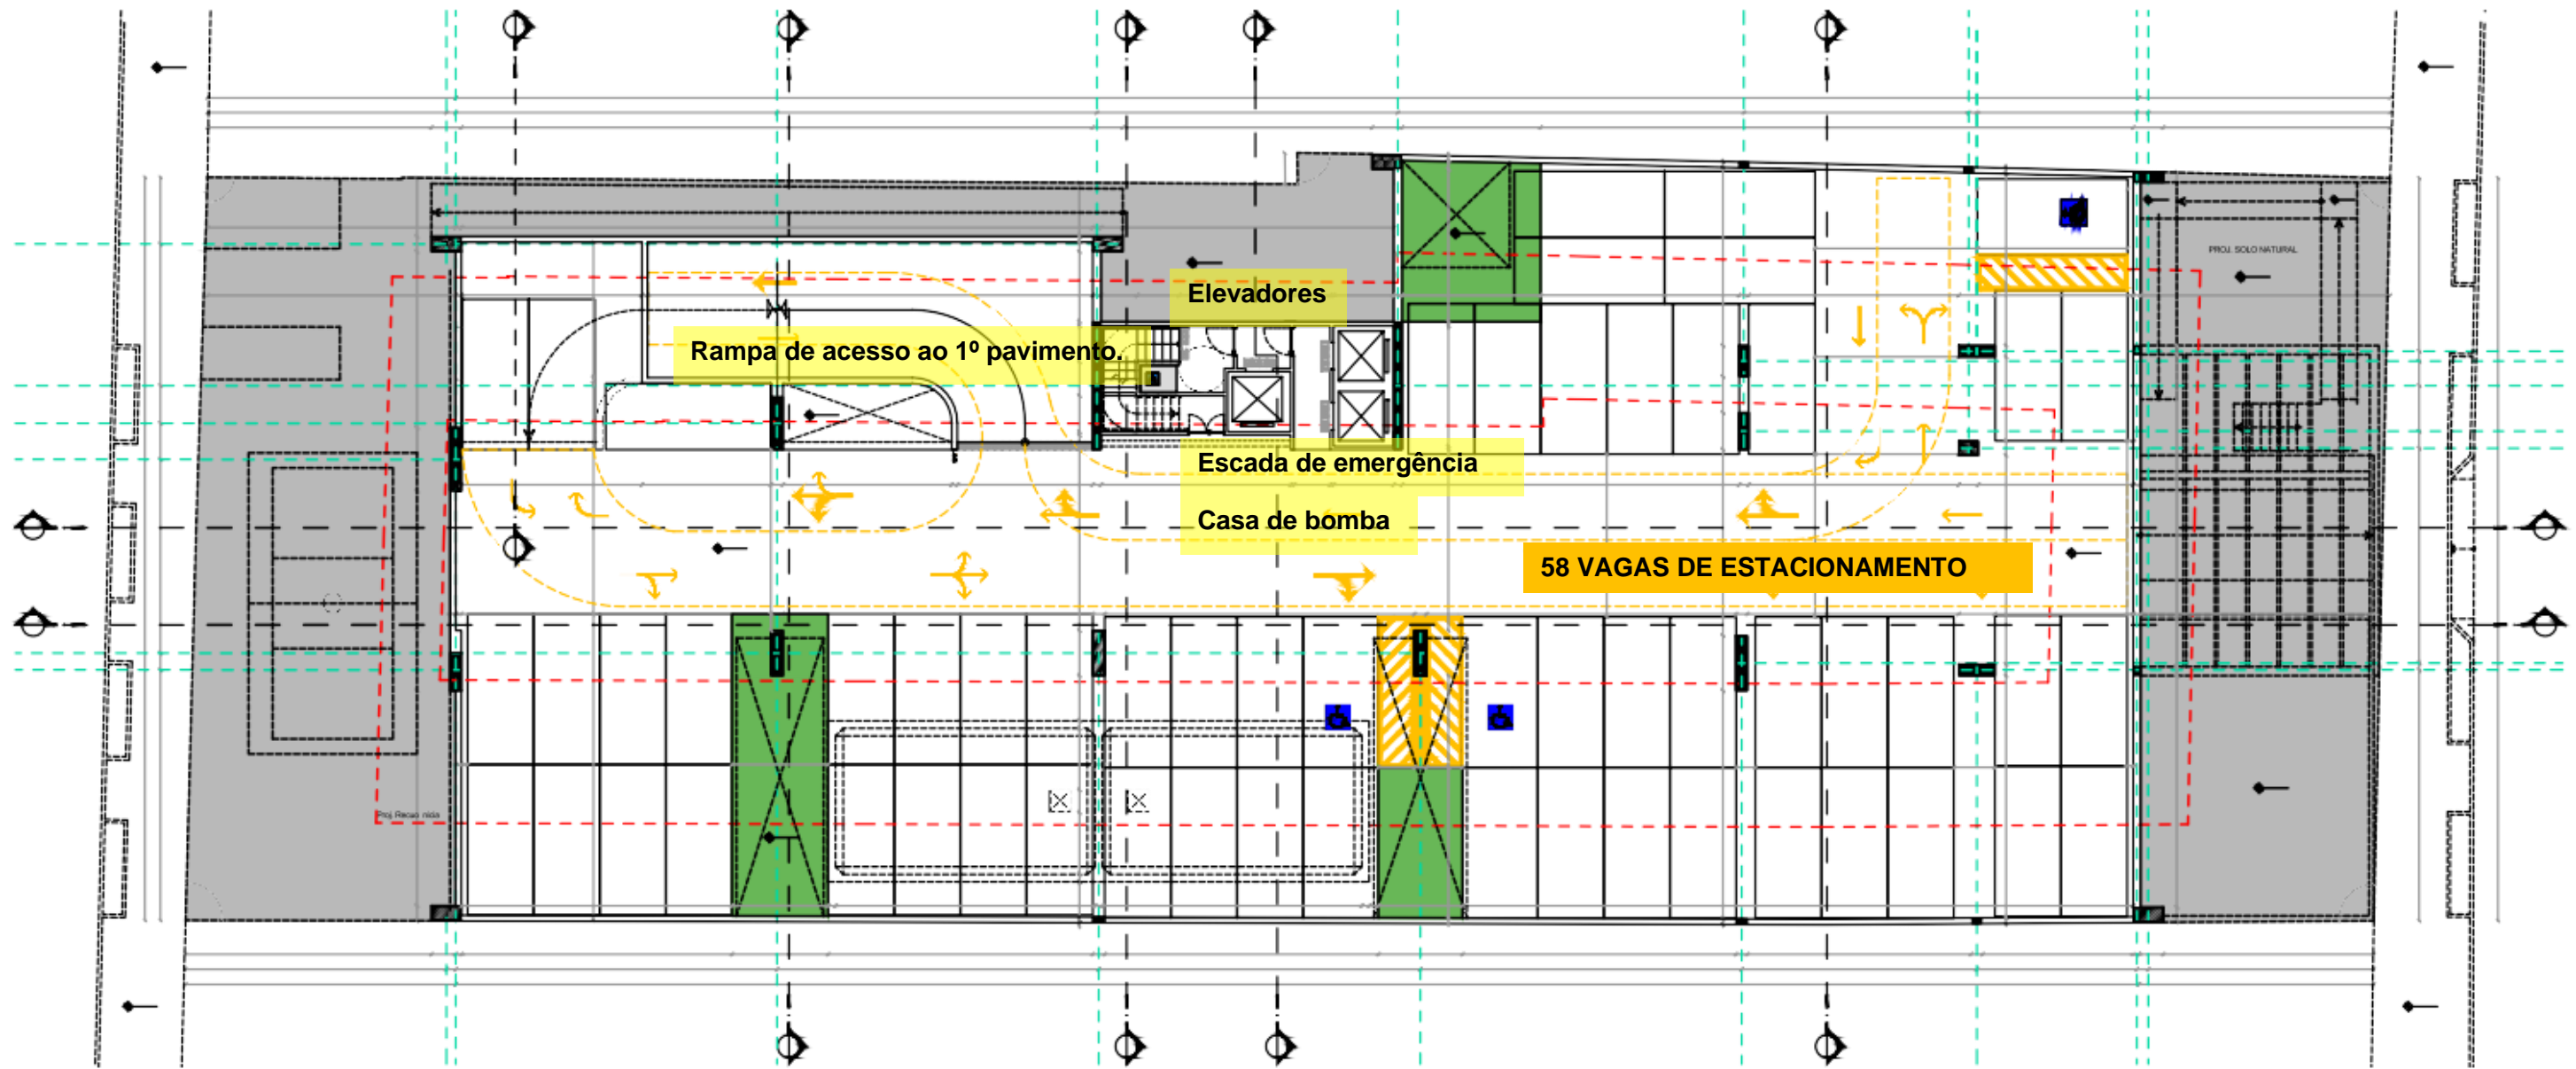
Planta Pavimento semi-enterrado – P02.13.
